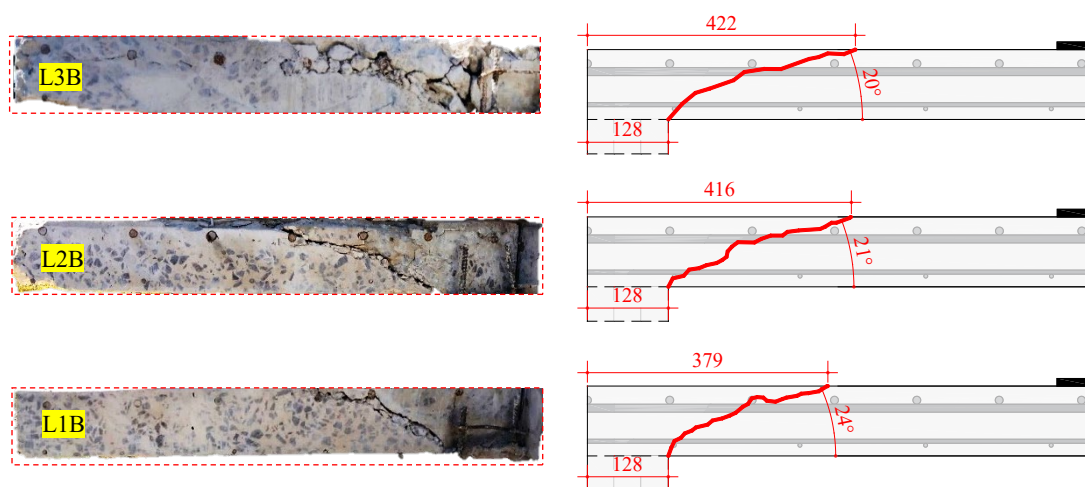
Corte das lajes da série B lado (y) paralelo ao $c_{máx}$ (mm)
